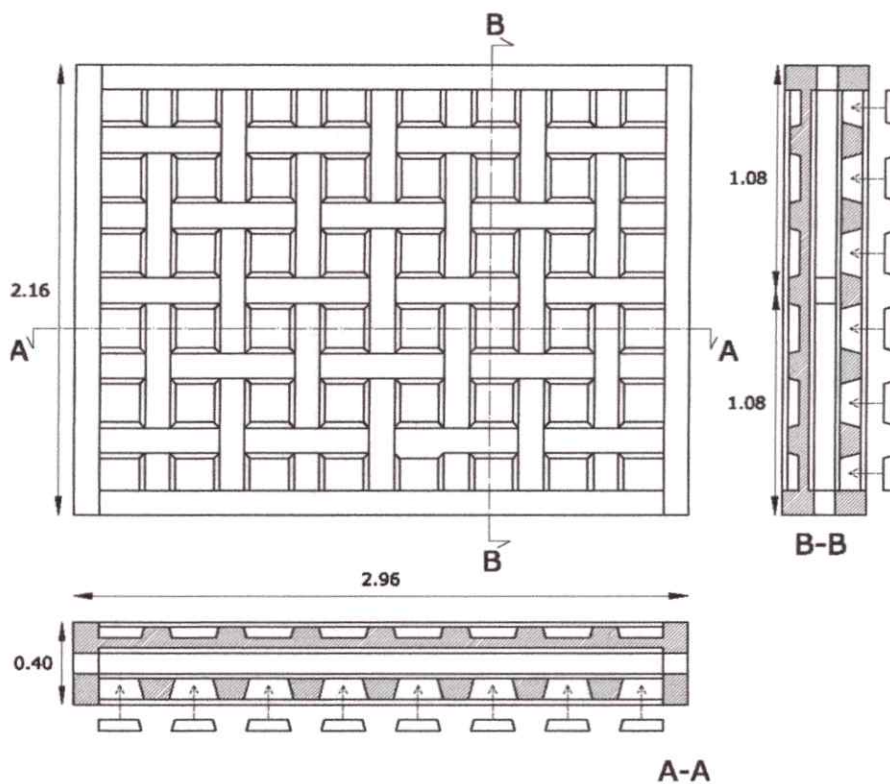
Élévation d'une structure en sandwich avec des dimensions en mètres. La figure montre également un coupe horizontal (AA) et un (BB) coupe verticale sur la structure. Ils affichent que les tuiles ne sont pas nécessaires pour la structure et ils sont placés seulement après l'assemblage de moellons. L'écart entre les panneaux peut être rempli d'un matériau isolant, source : Journal of Space Structures
